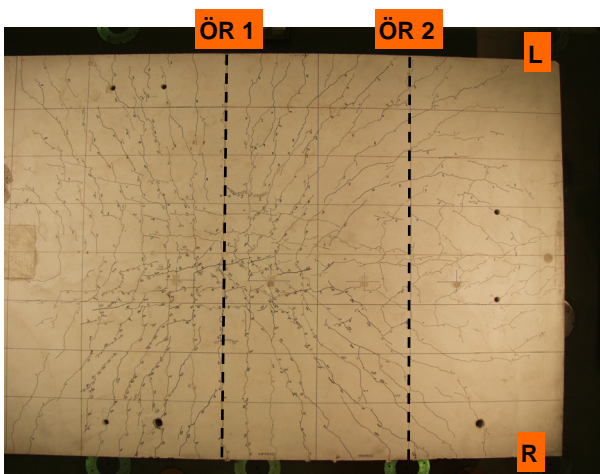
Rissbild auf der Betongurtoberseite
